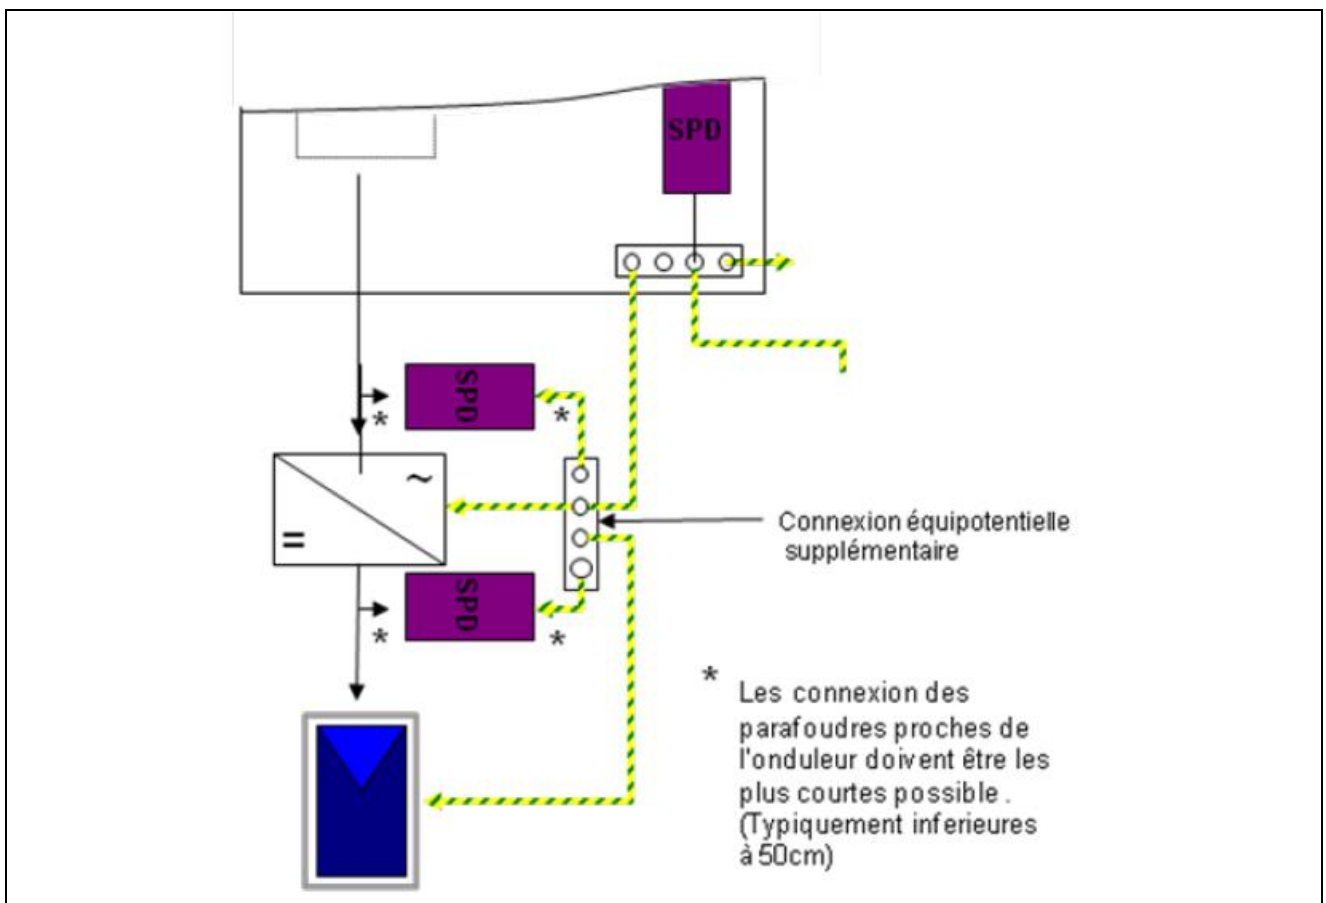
Implantation des parafoudres sur l'installation PV. (UTE 15-712)
